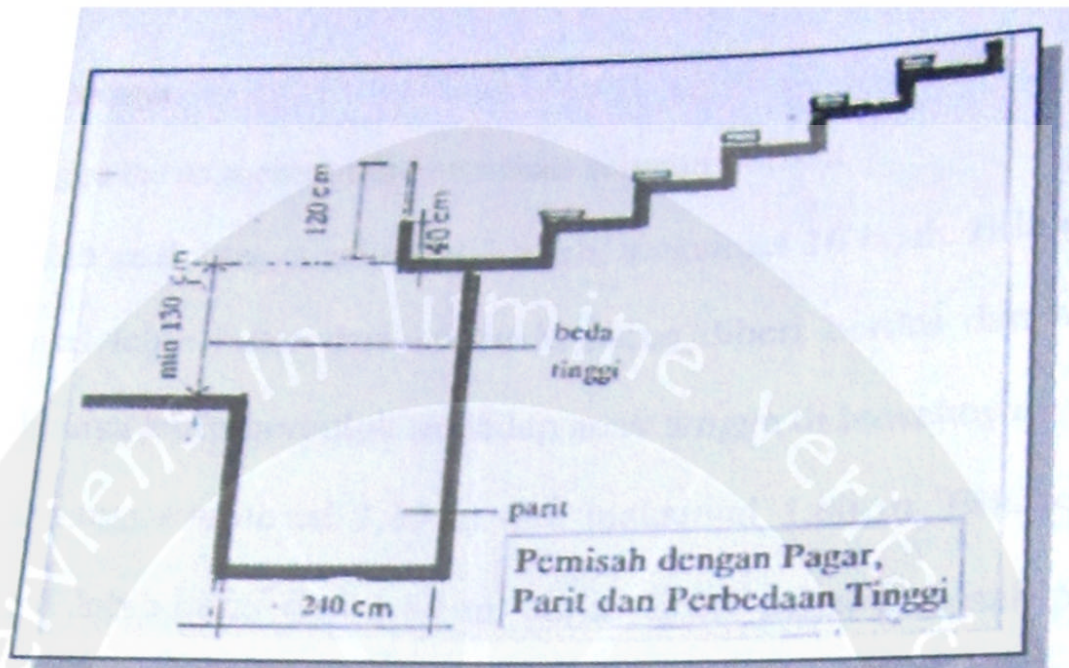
Konstruksi garis pandang penonton pada tribun.
